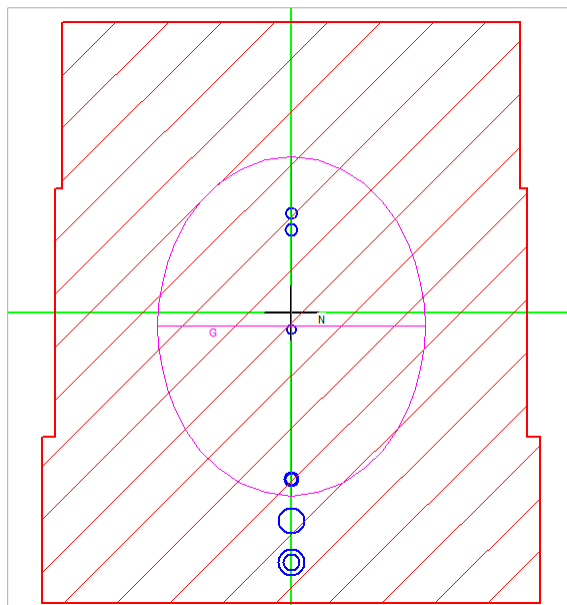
Trave in C.A.P. e getto di completamento, sezione omogeneizzata.
